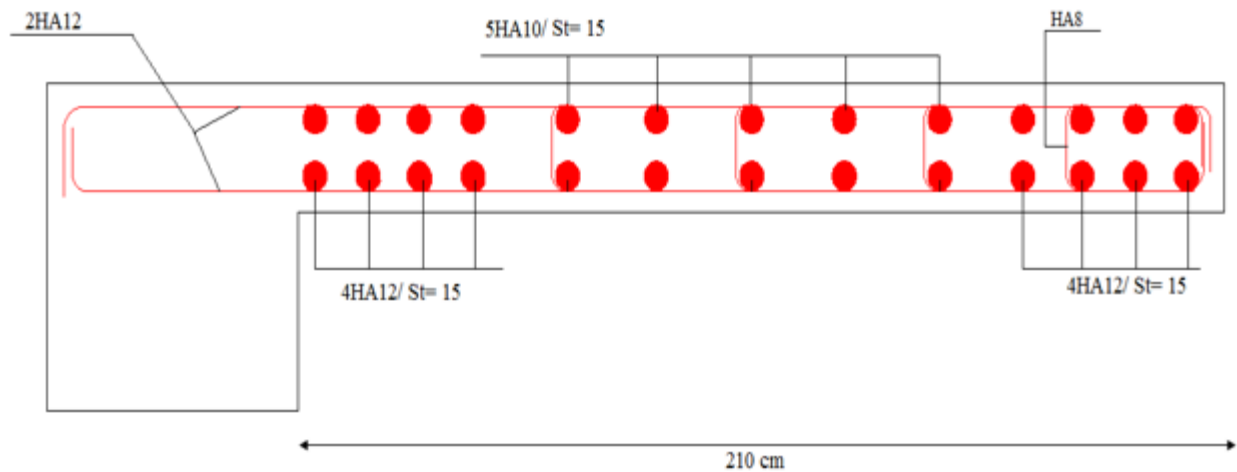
Schéma de ferrailage du voile Vy1, Vy3. (Niveau RDC.).
